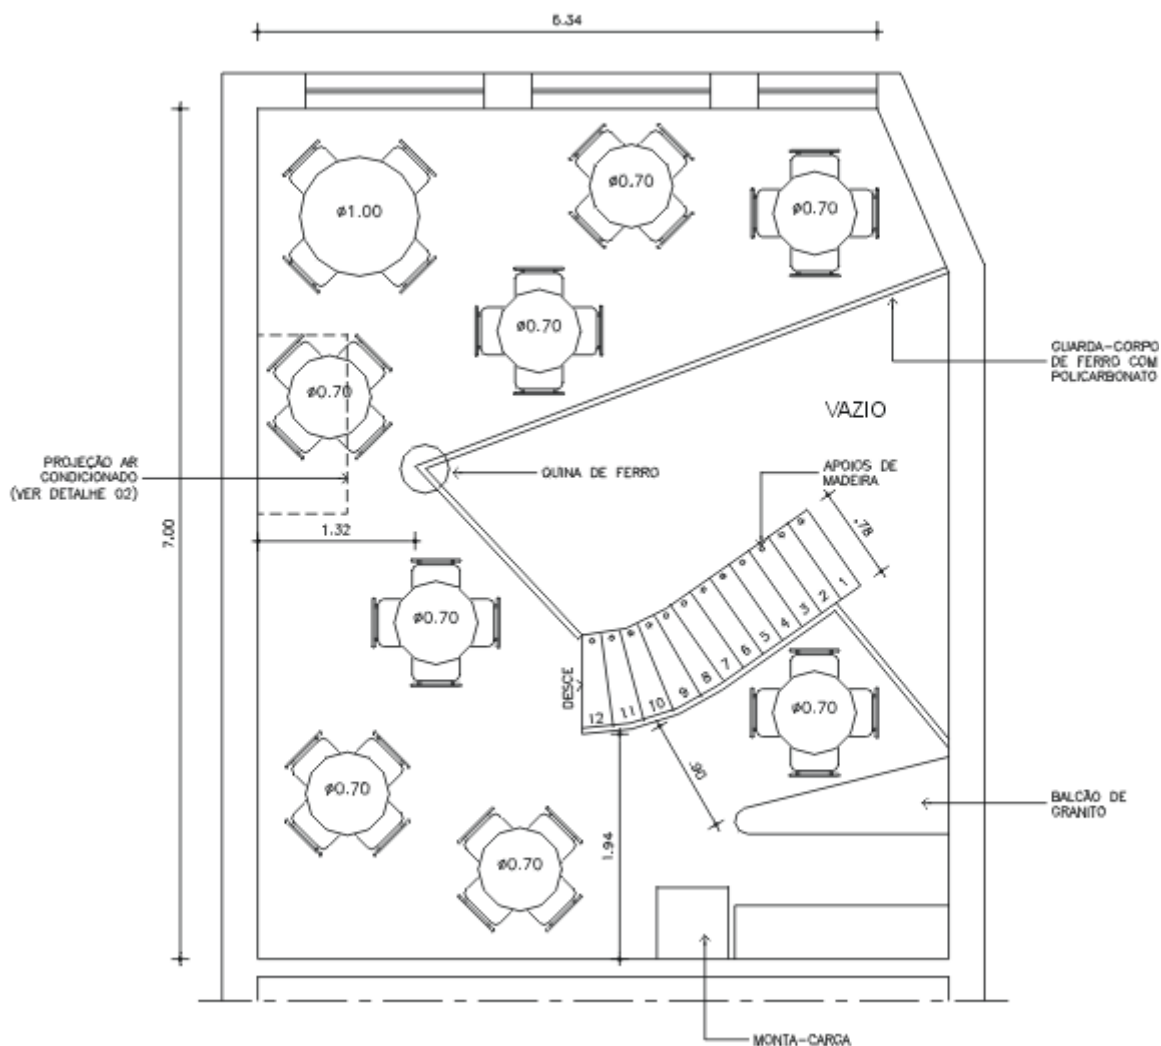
Planta baixa (lay-out) do mezanino do restaurante “C”.l
